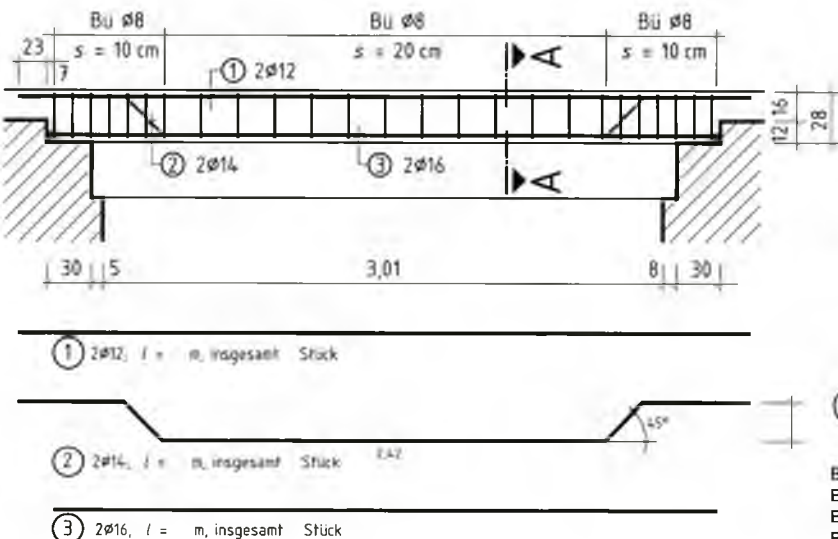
/1: Bewehrungsplan (Stahlbetonsturz)
